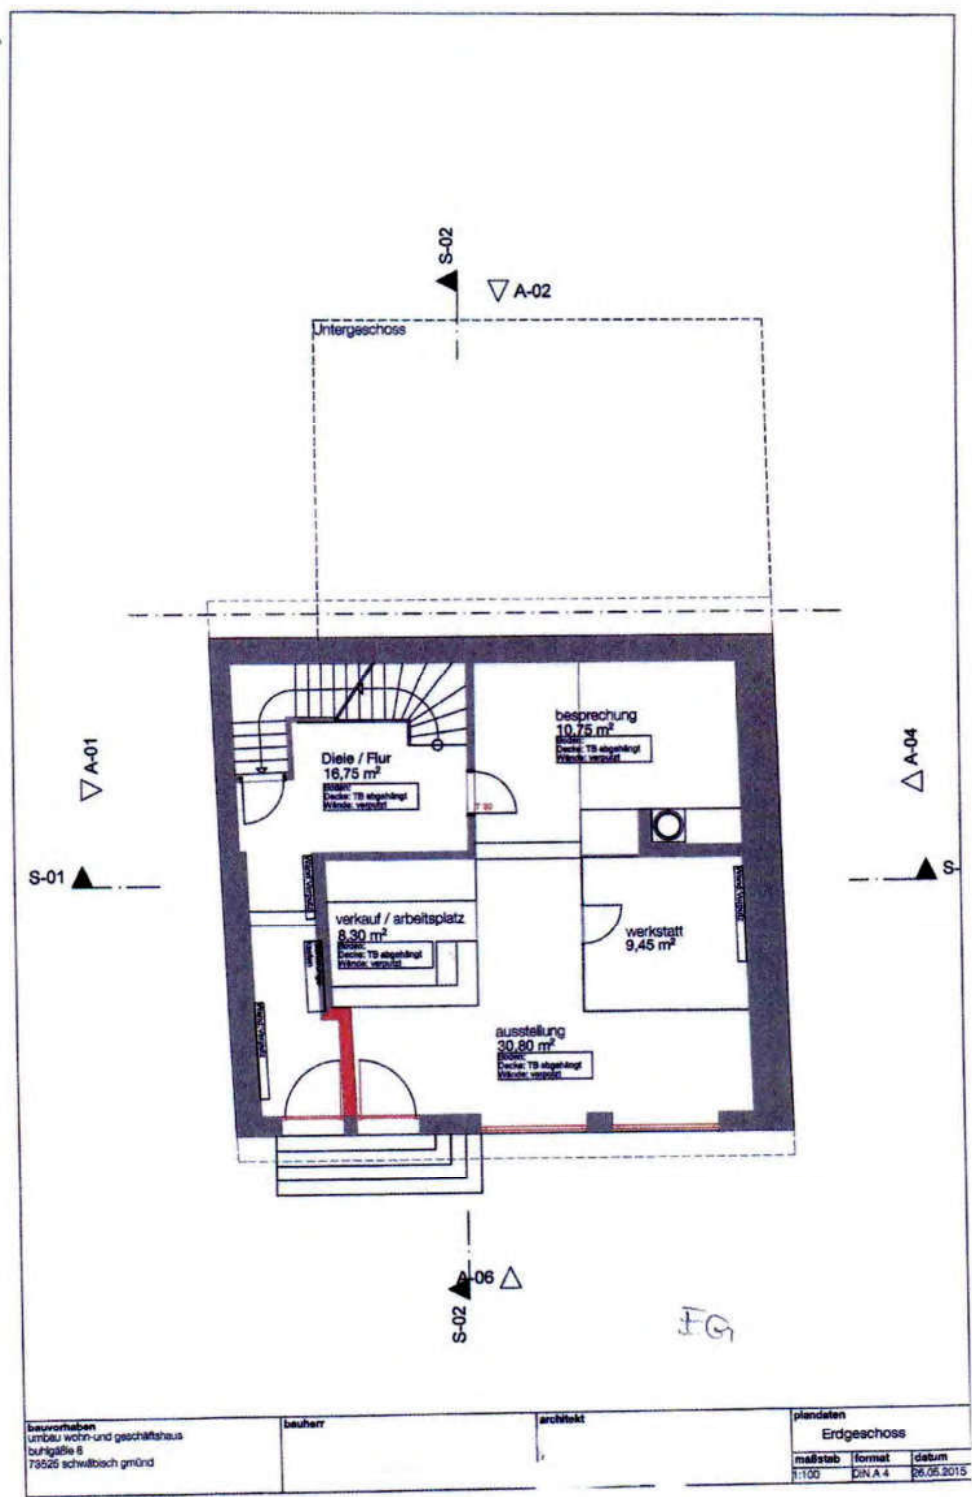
Erdgeschoss mit Treppenhaus und Laden
